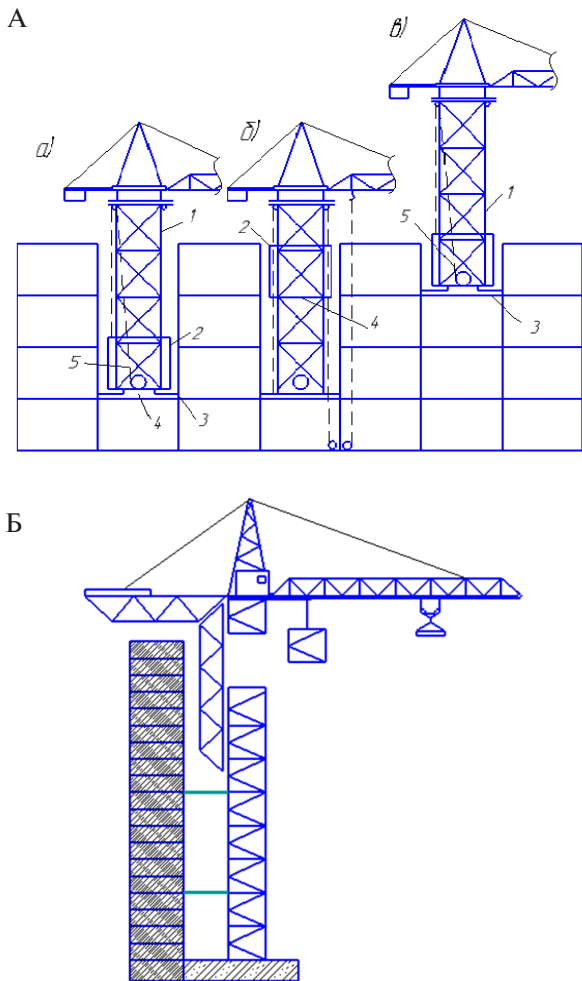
Схемы самоподъемного (А) и приставного (Б) башенного кранов: а) исходное положение; б) подъем обоймы; в) подъем крана. 1 – башня крана; 2 – подвижная обойма; 3 – откидные упоры опорной балки; 4 – откидные упоры подвижной обоймы; 5 – специальная лебедка
